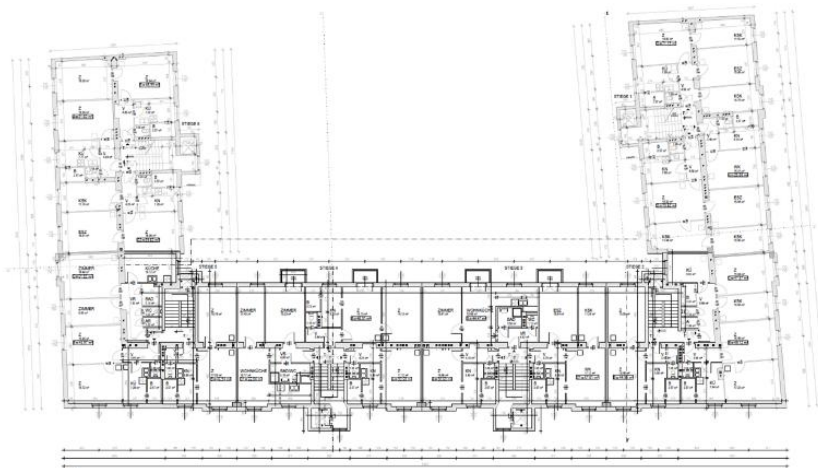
Verwendeter Grundrissplan des 3. Stockwerks für den Modellaufbau in IDA ICE in der Gerlgasse (eigene Darstellung).
